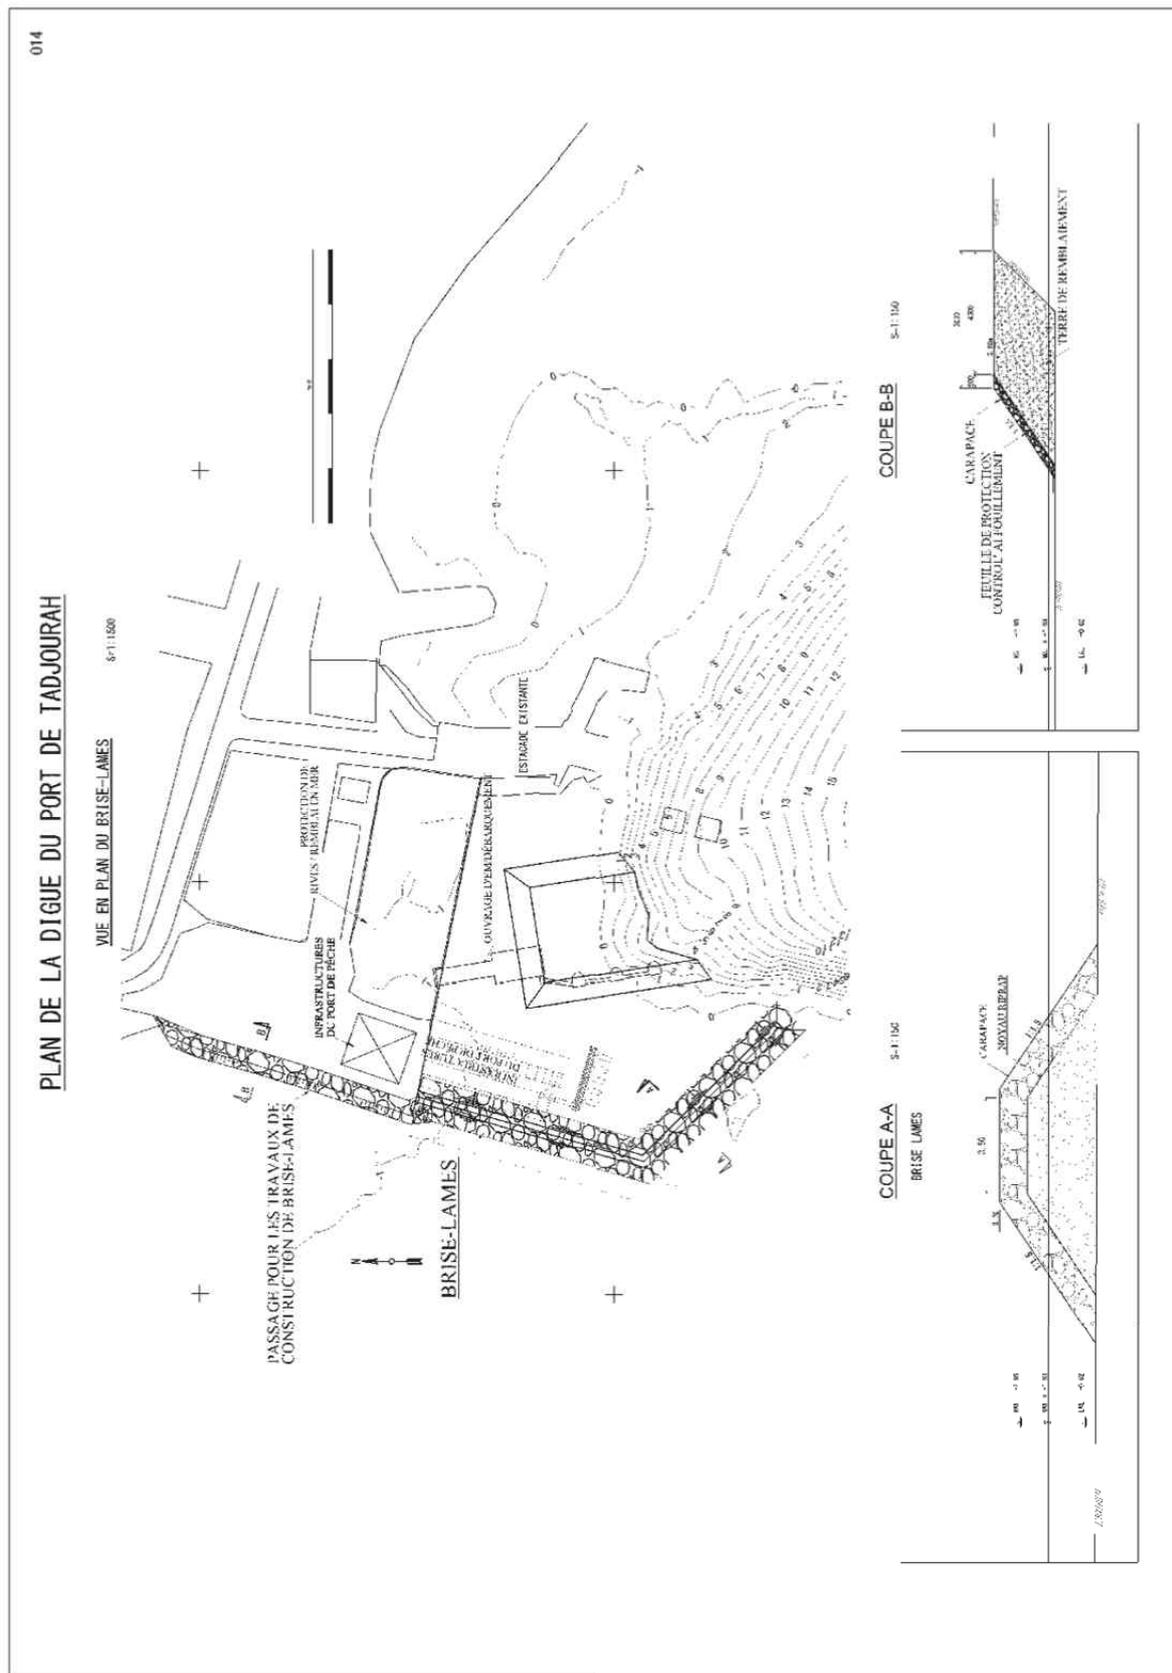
Plan du brise-lames du Port de Tadjourah
